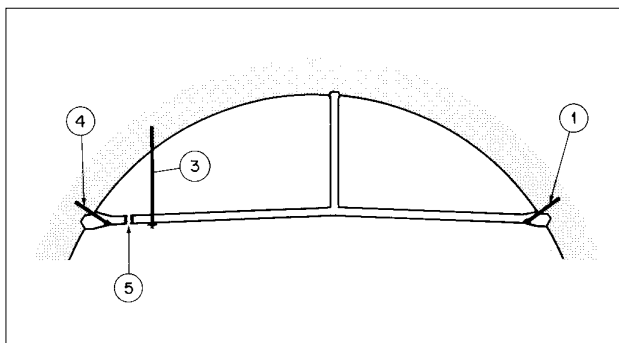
Mesures de réfection de la dalle (décharge de la poussée de la voûte)
